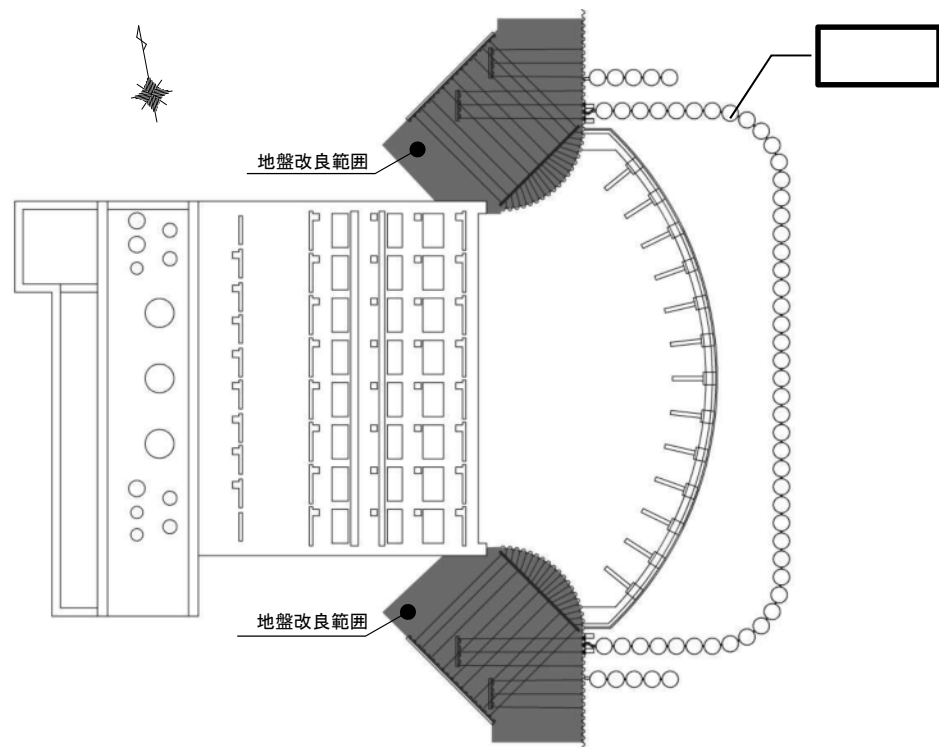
(2) 貯留堰の平面配置図（拡大図）
